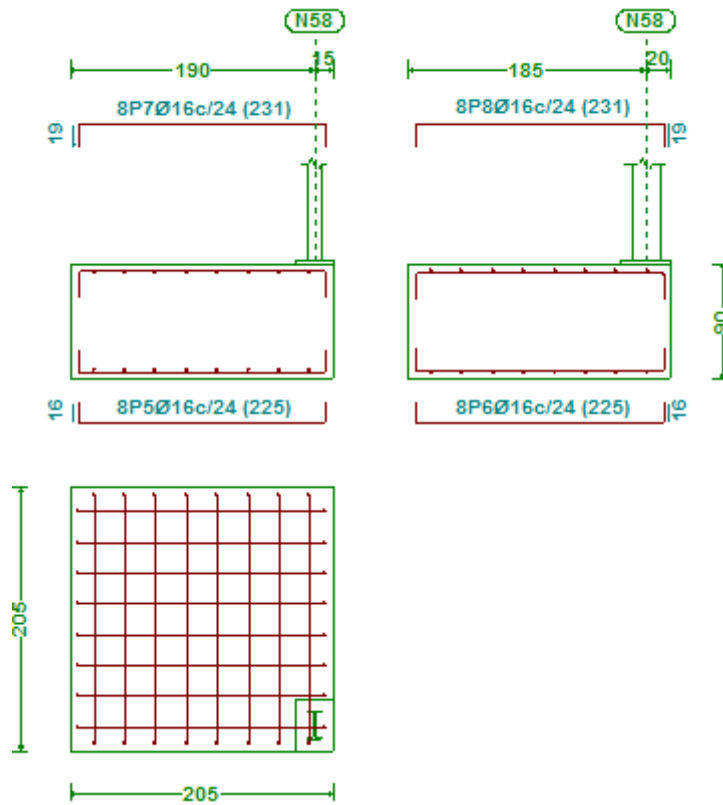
Zapata pilar exterior derecho del pórtico de fachada (Tipo 6)
